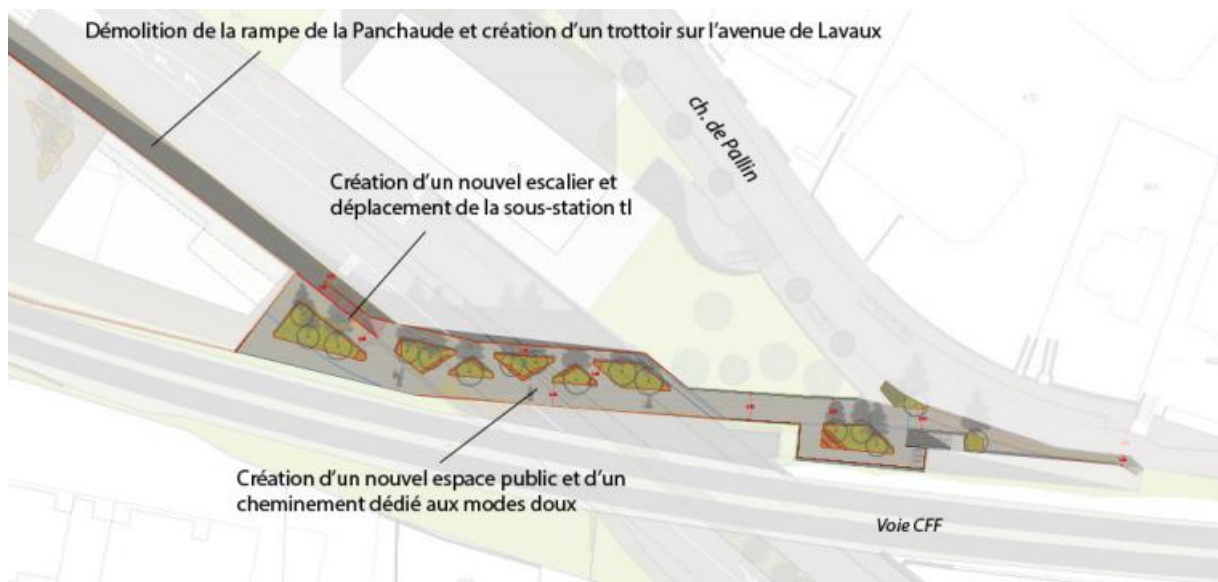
vue sur le Pont de la Panchaude - @Ville de Pully
